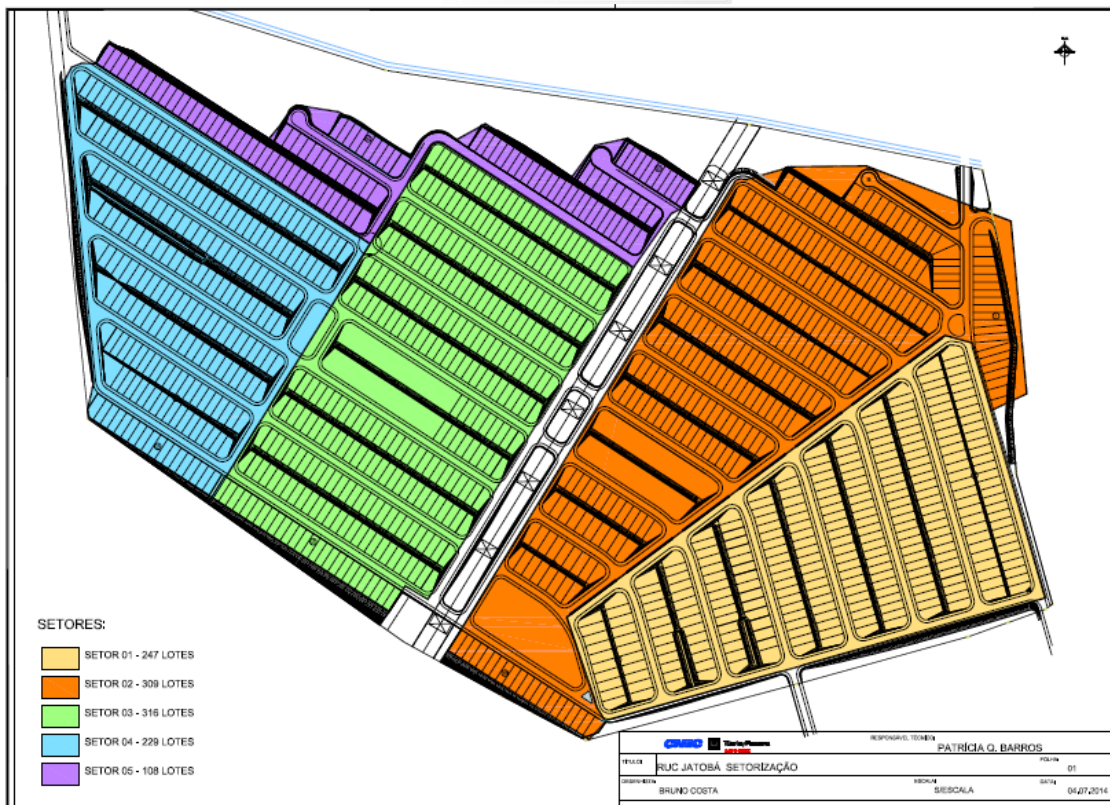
1 - Setorização do bairro Jatobá.
